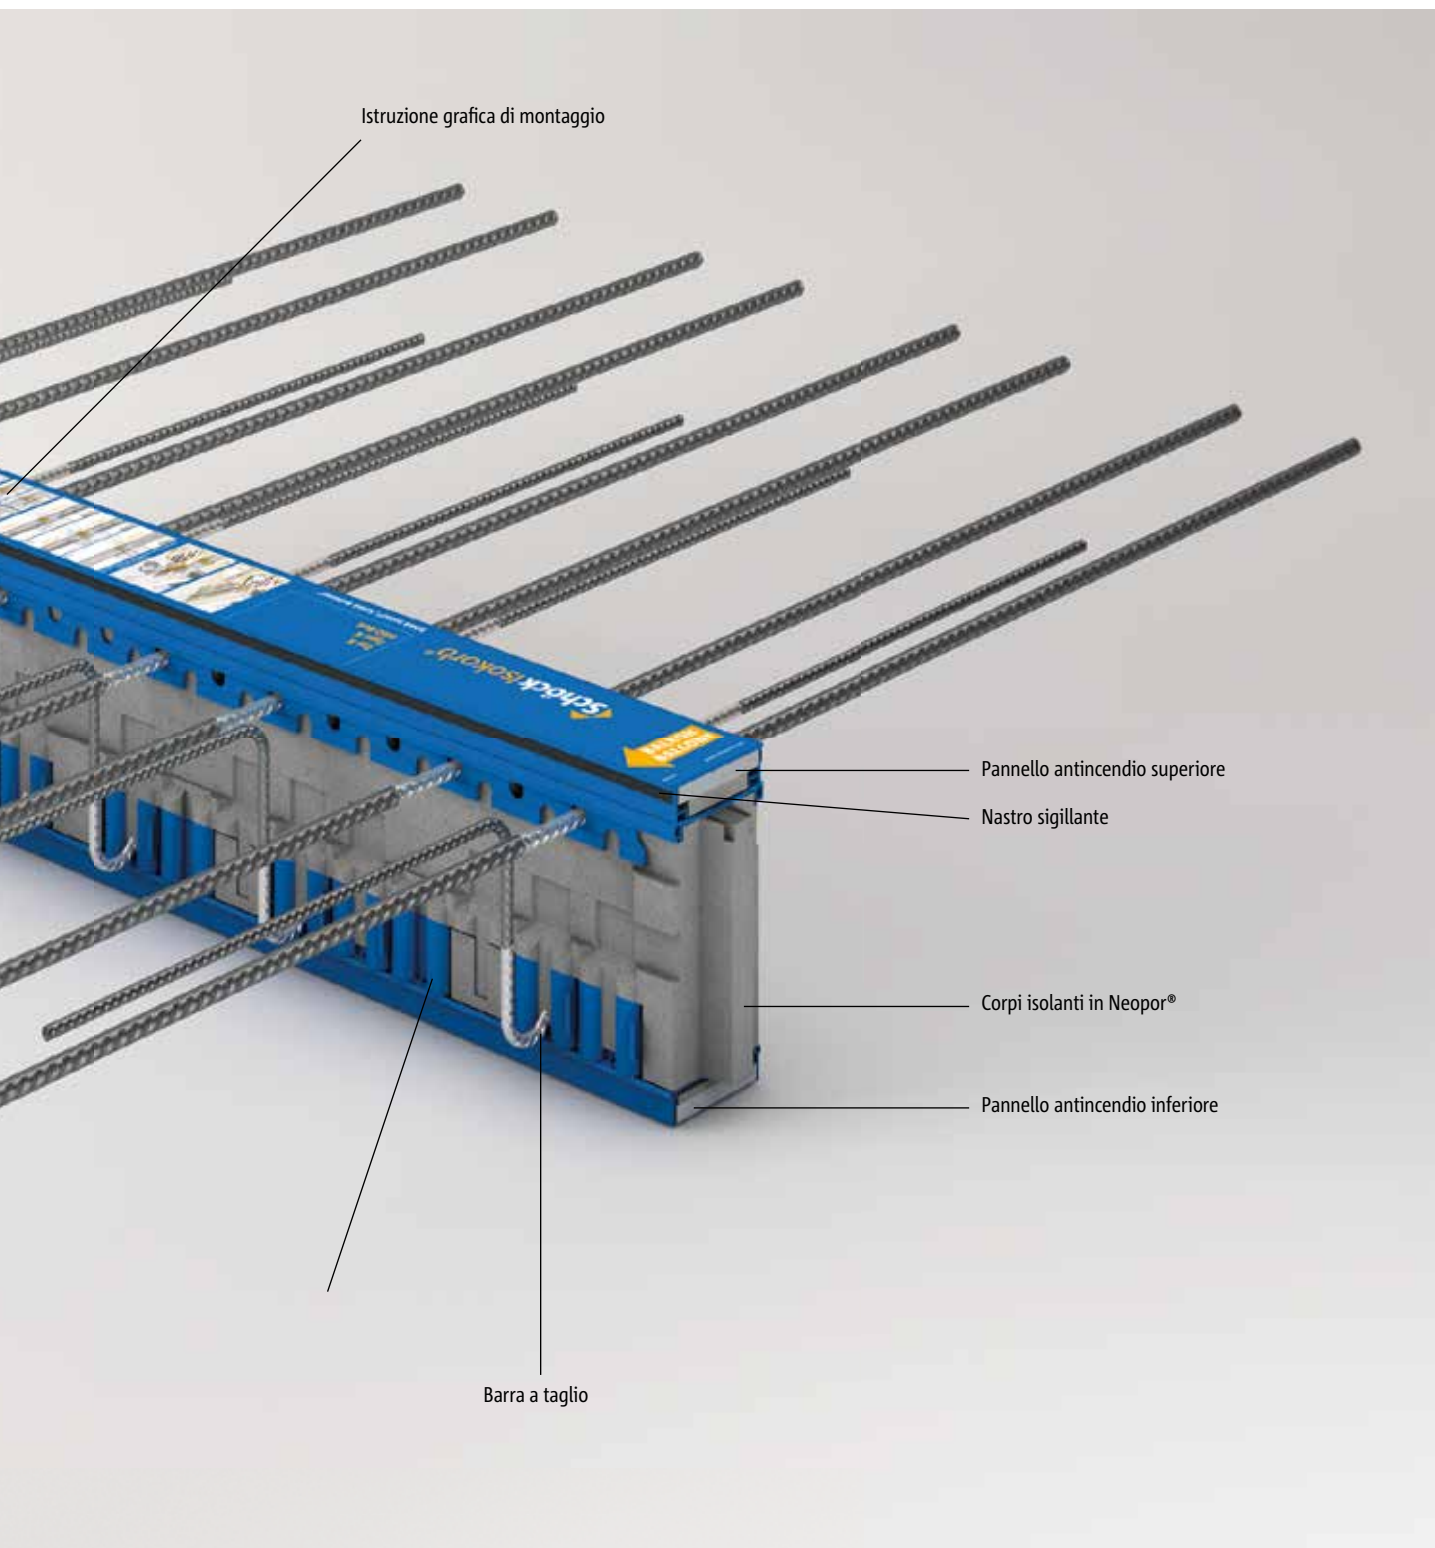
Schöck Isokorb® T tipo KL: componenti
